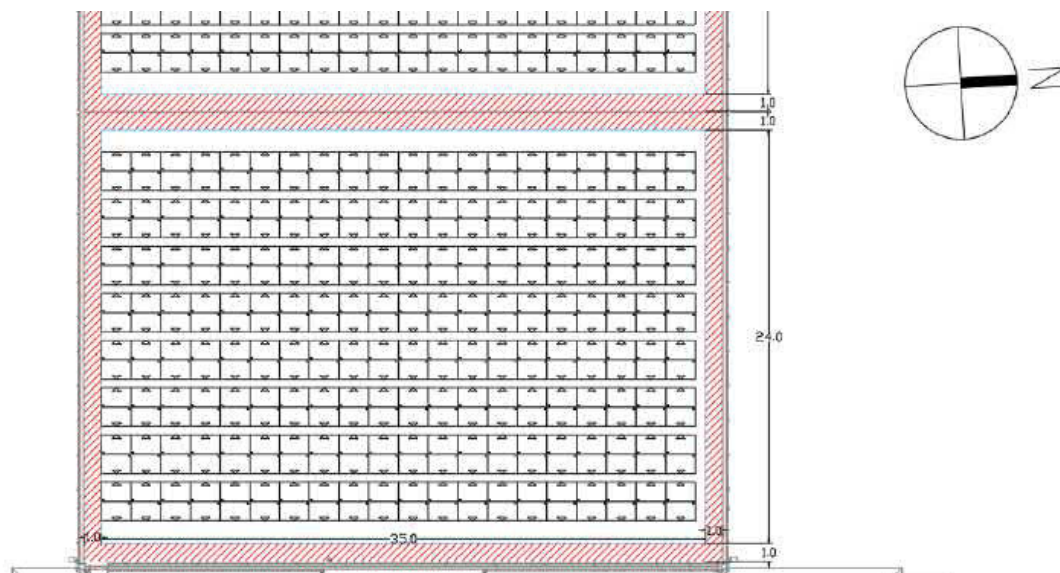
Dachfläche U-12/U-22, je Dachfläche ca. 320 Module, je Dachfläche ca. 128 kWp, Neigung 10°
